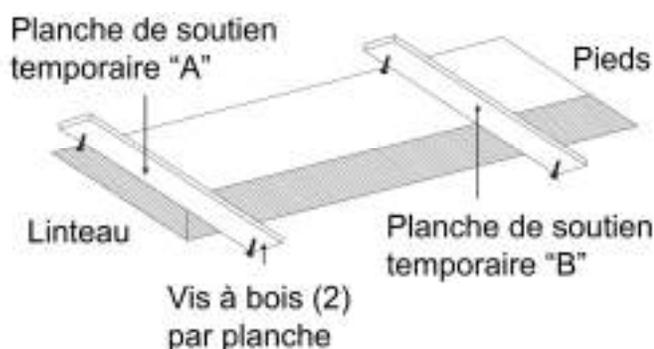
INSTALLATION DES PLANCHES DE SOUTIEN
